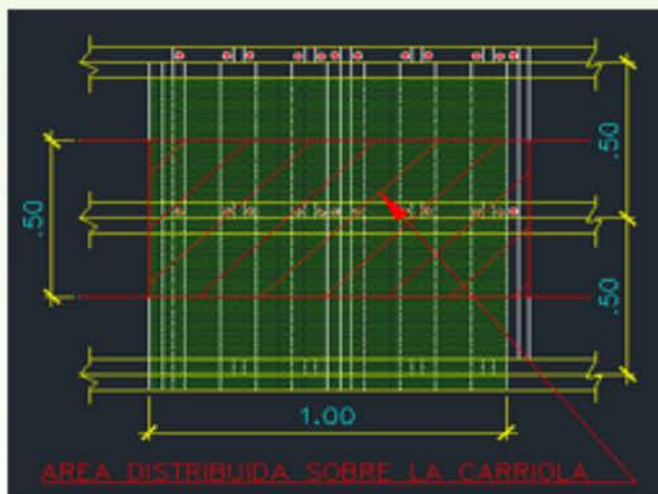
Vista de planta de la colocación de los módulos de techo verde. Fuente: Autor.
